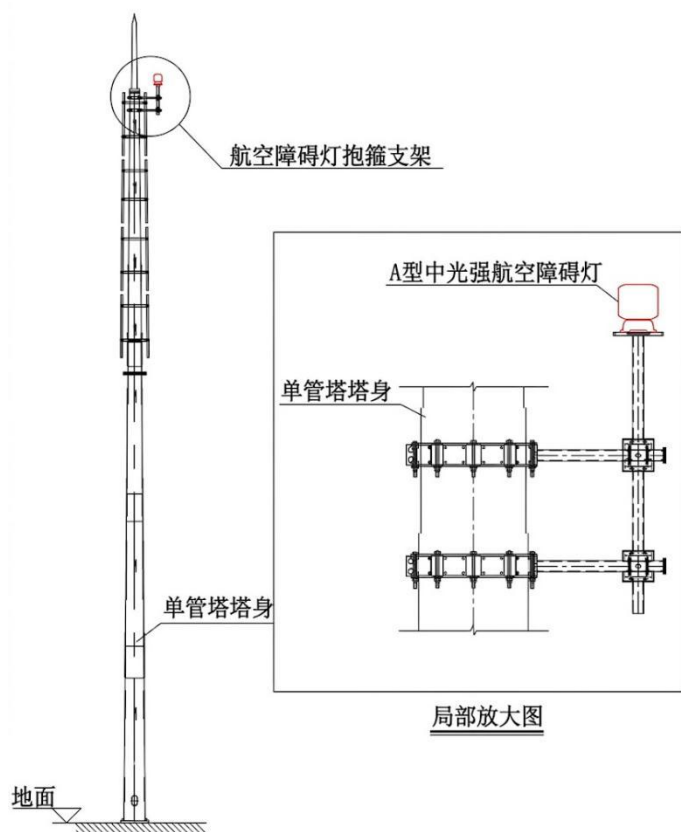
单管塔设置航空障碍灯支架立面图
